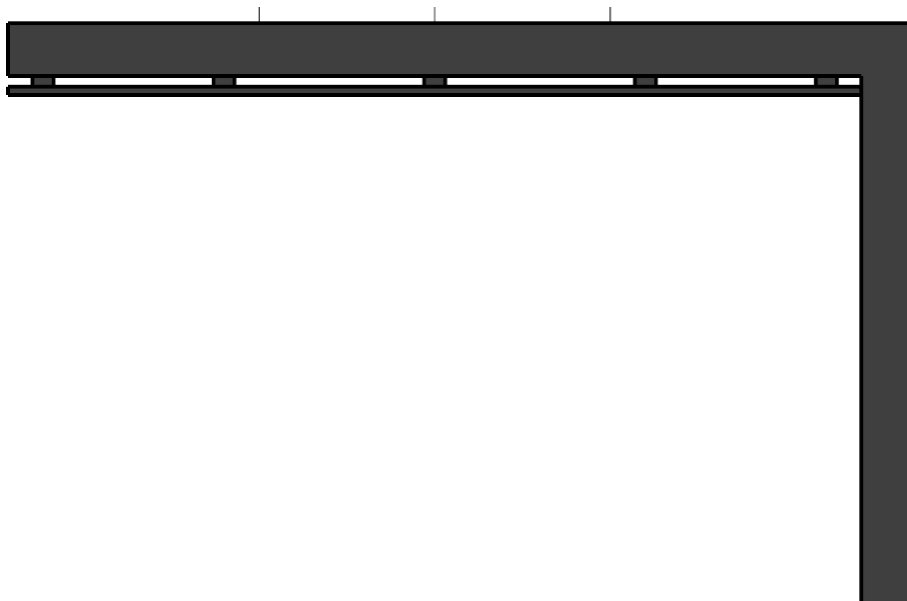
Horizontalschnitt des Prüfstandes mit Fassadenaufbau in 2 m Höhe. Die horizontale Brandsperrre auf 1,75 m Höhe ist hier ausgeblendet.
